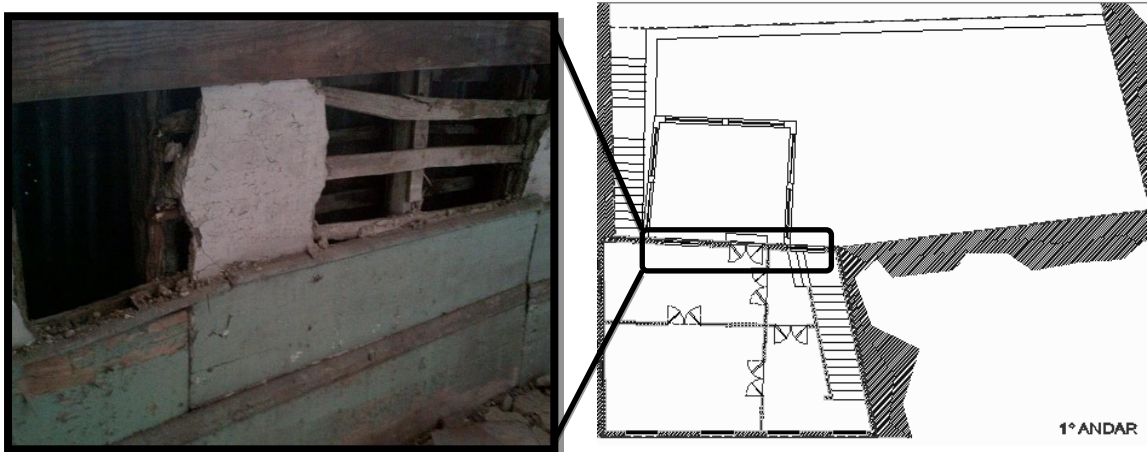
Anomalia 12 - Fotografia e localização em planta
